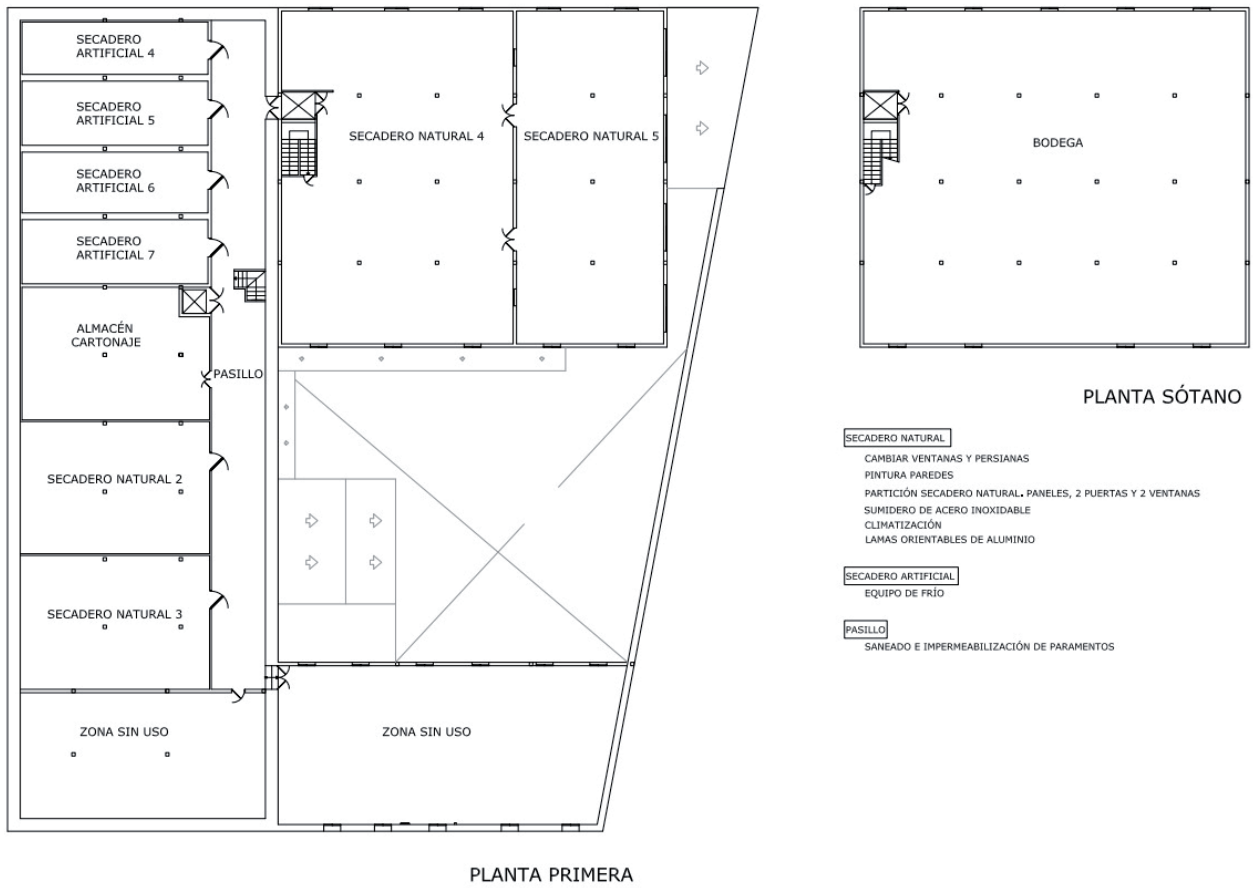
Situación proyectada de las instalaciones de la planta primera y sótano
